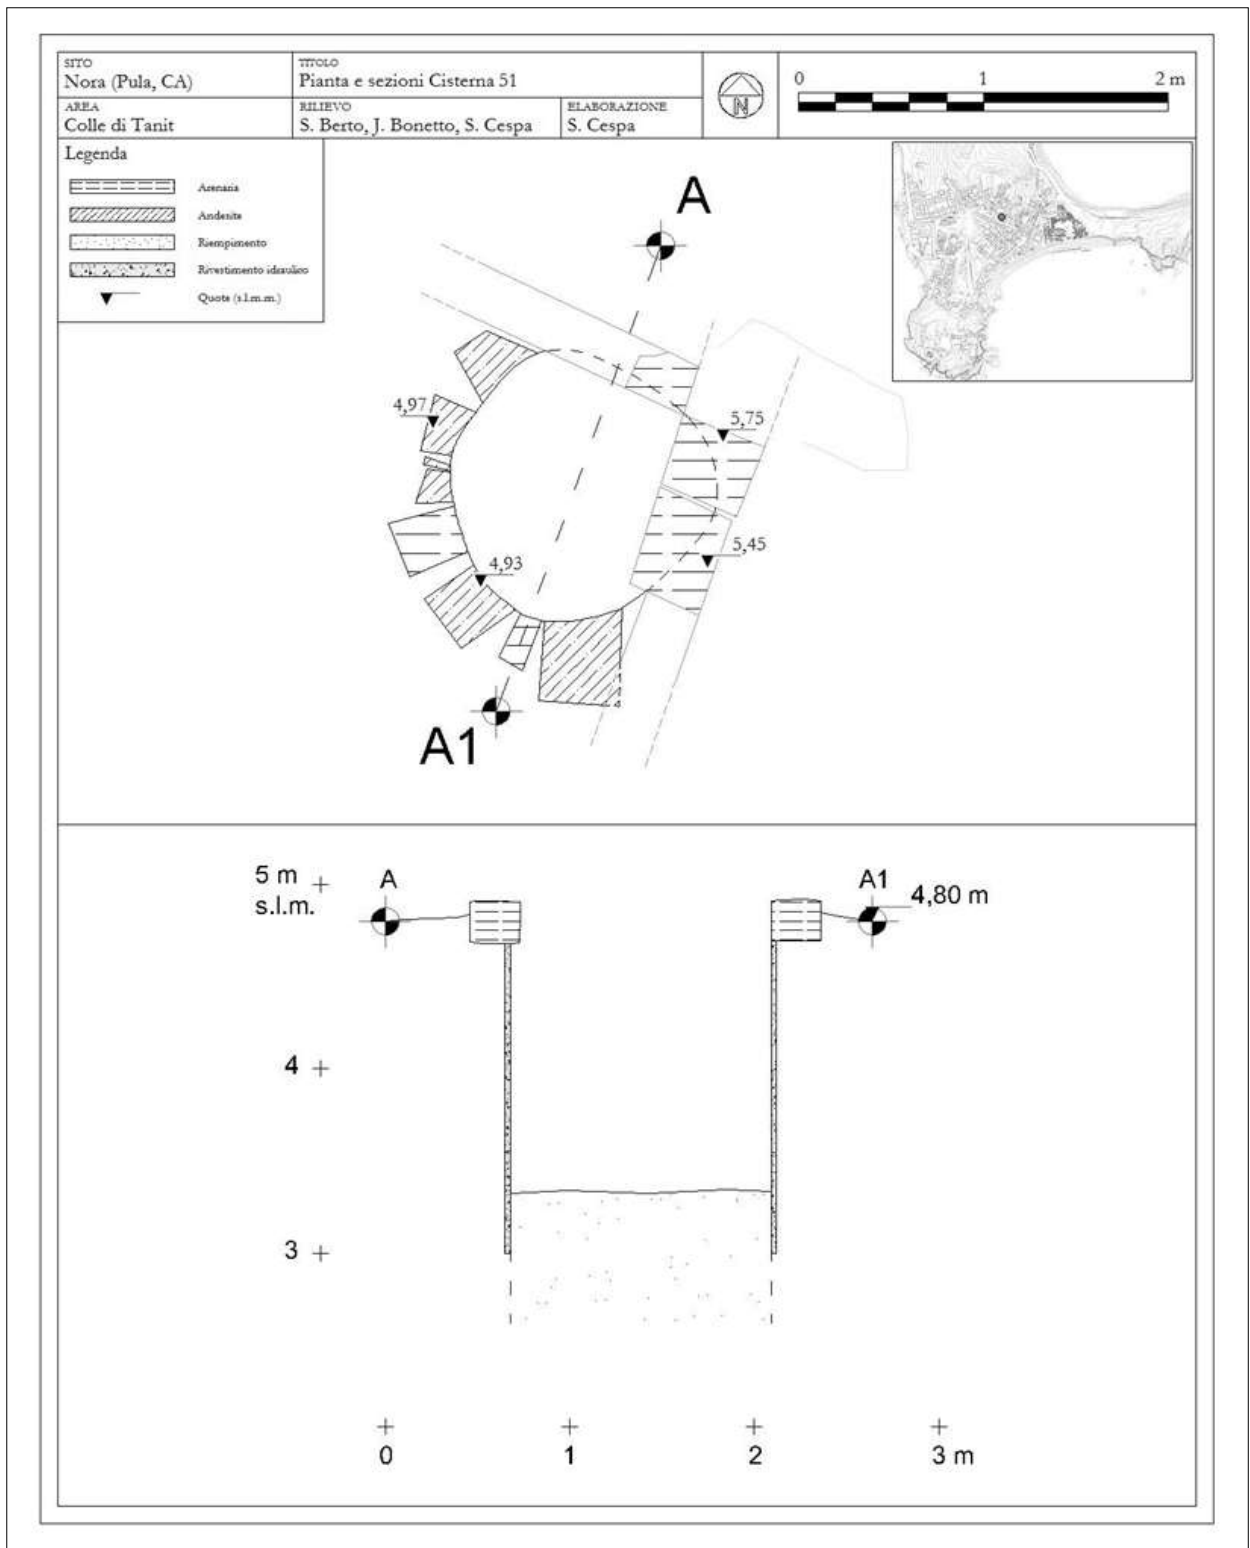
Pianta e sezione della cisterna 51 (elaborazione dell'autore).
